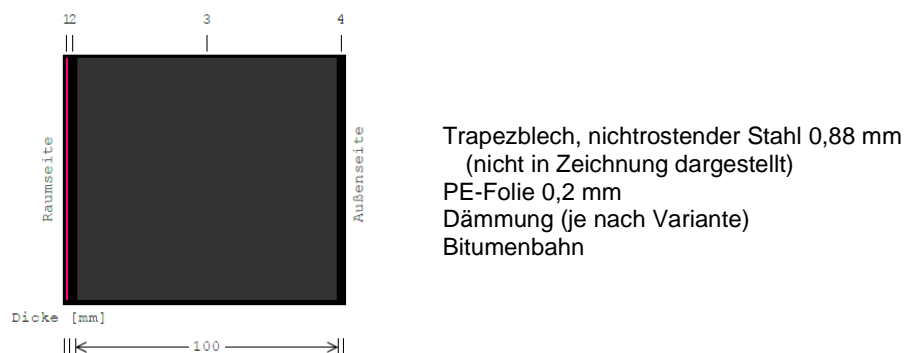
Schematische Darstellung der Außenwandaufbaus der Lagerhalle mit Sandwichelementen (ZUB Systems GmbH 2019)
